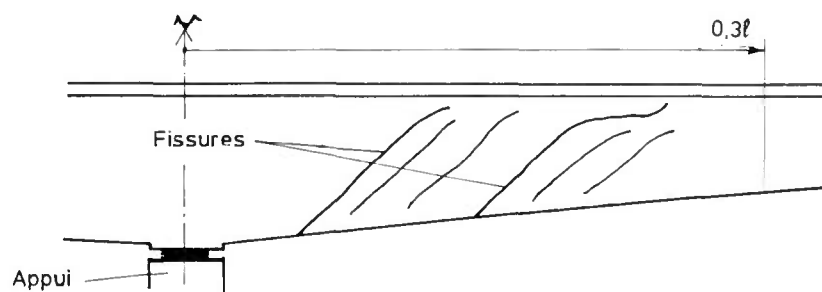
Zones où se rencontrent préférentiellement les fissures d'effort tranchant.
